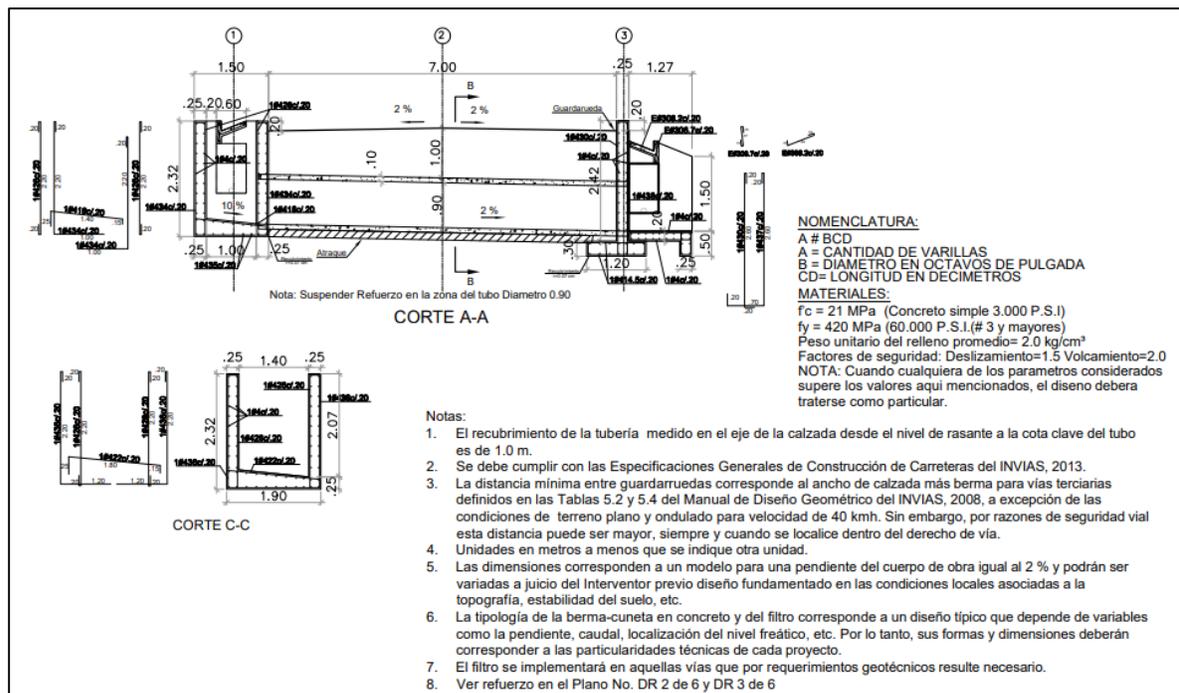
Detalle refuerzo Alcantarilla con muros en concreto reforzado Poceta – Aleta.
